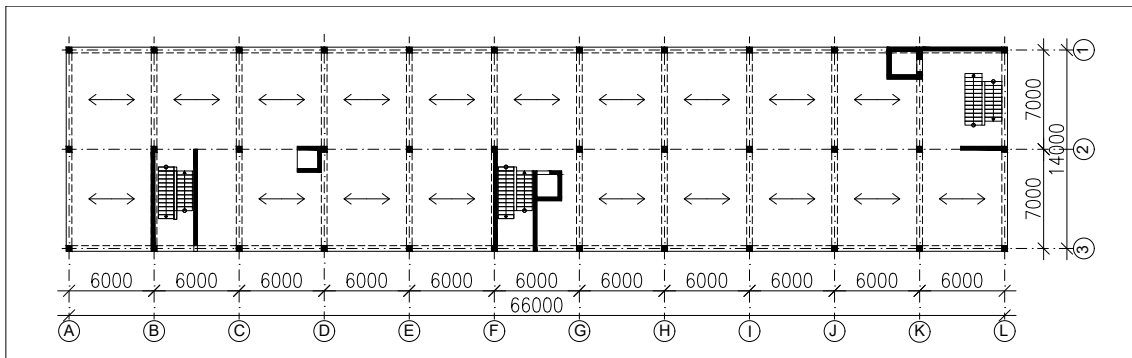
Schéma konstrukčního řešení střechy navržené u všech čtyř variant
